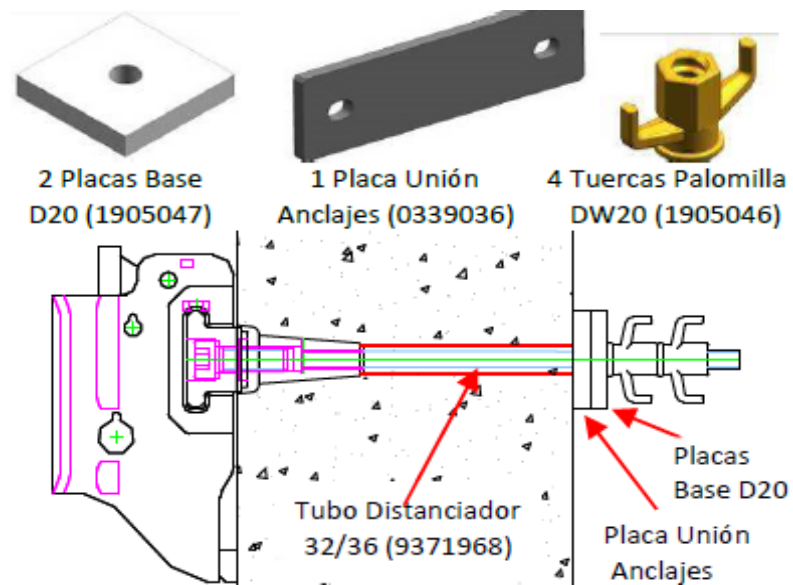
Detalle del anclaje pasante, que sobresale hasta el otro lado del muro. Recuperado de: Ulma Construction, *Consolas autotrepantes*.
